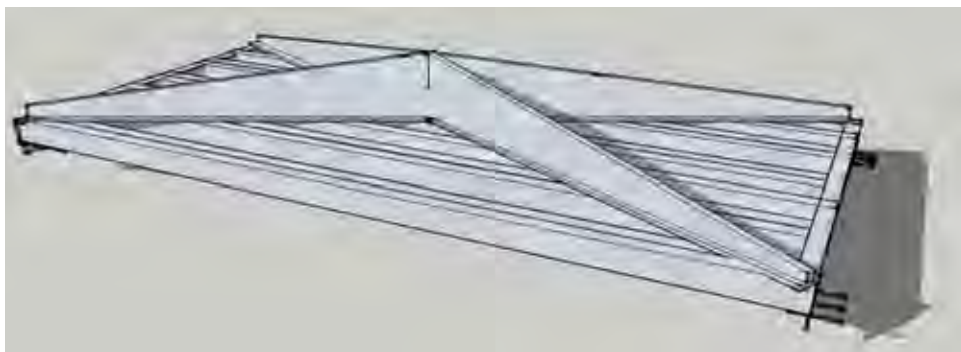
Armado del techo. Fuente: Elaboración propia 2008
